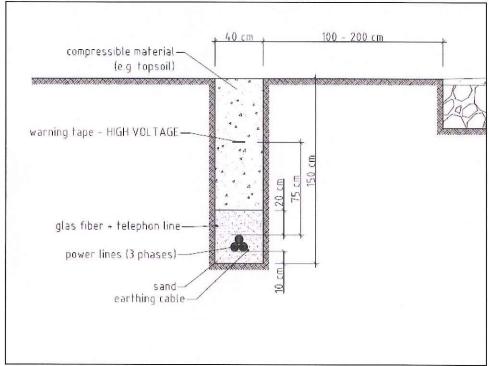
Esquema de perfil de zanja de cableado interno con un cable.
